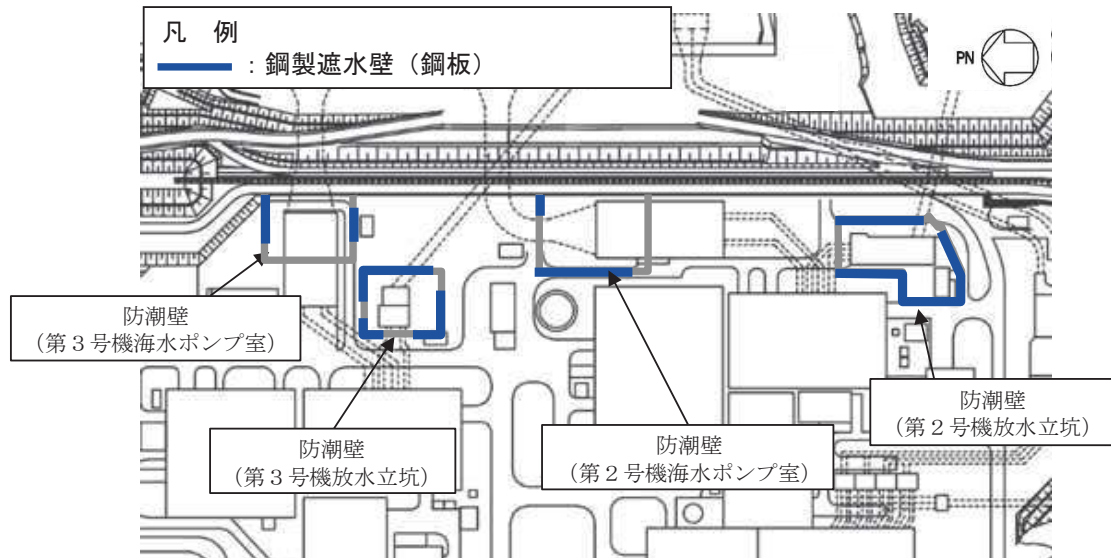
鋼製遮水壁（鋼板）の平面配置図
